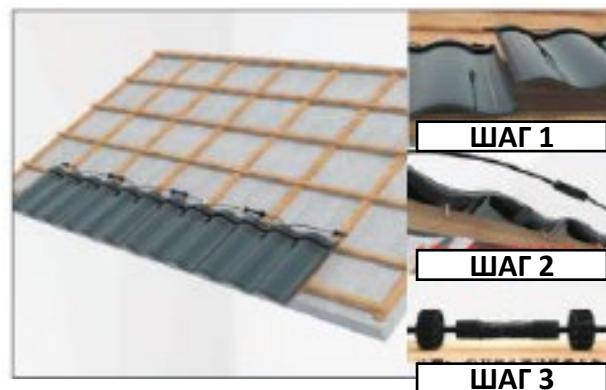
Установка солнечной черепицы на бетонной крыше
